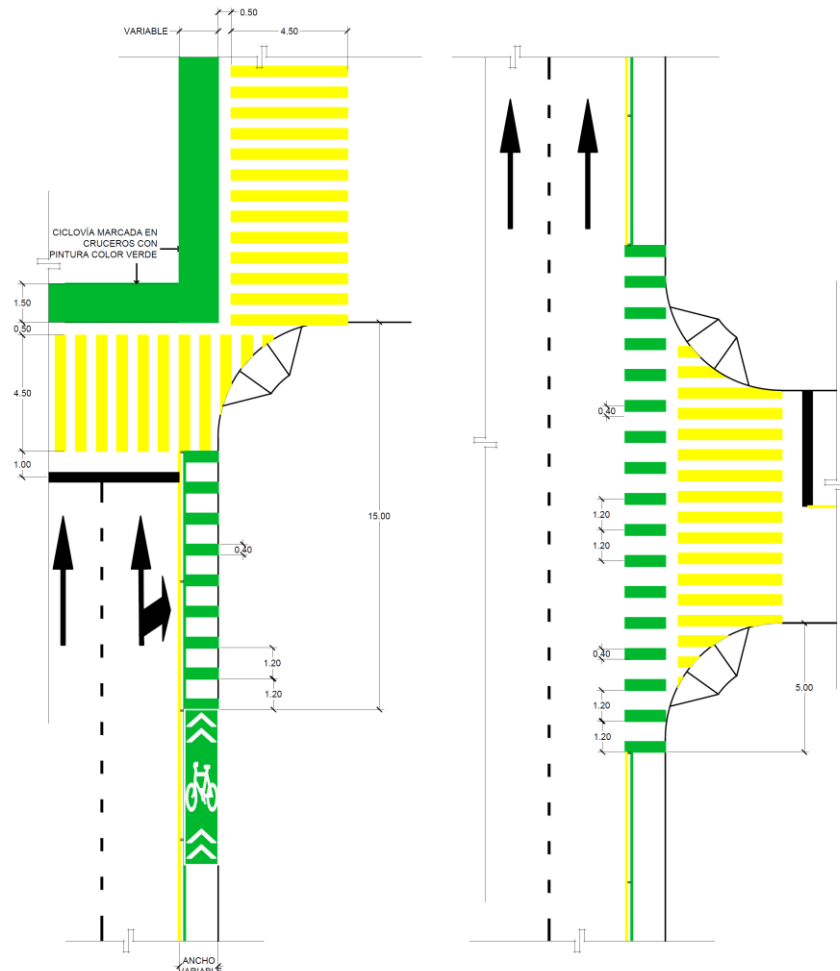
Detalle de señalamiento horizontal Tipo 1.
